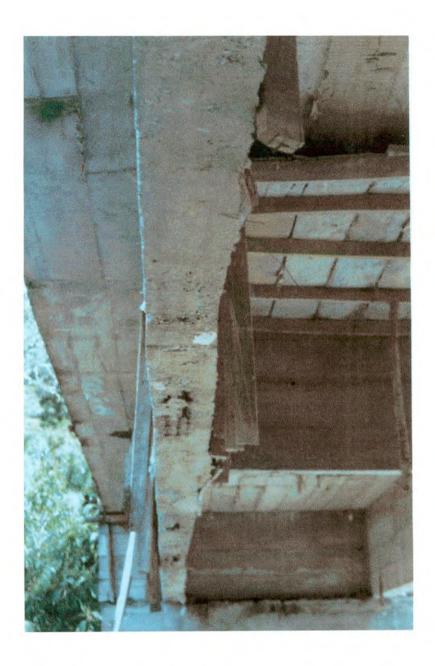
Presencia de formaleta de obra alrededor delas vigas
